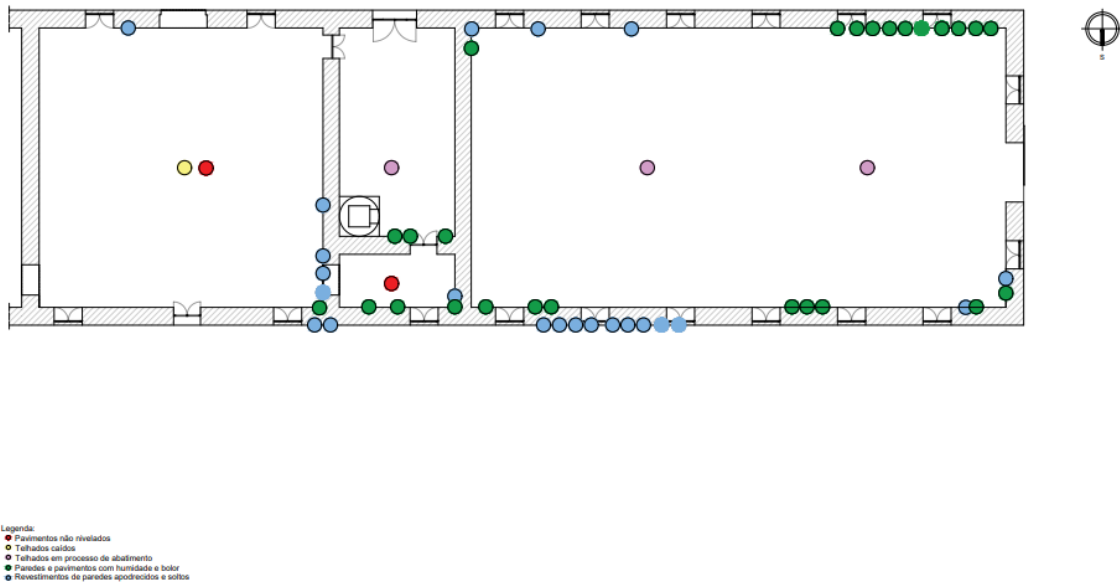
Planta de Patologias, Antigo Lagar de Azeite
